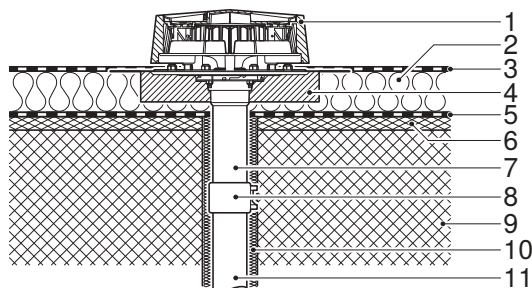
Montage dans toiture massive isolée avec revêtement d'étanchéité
